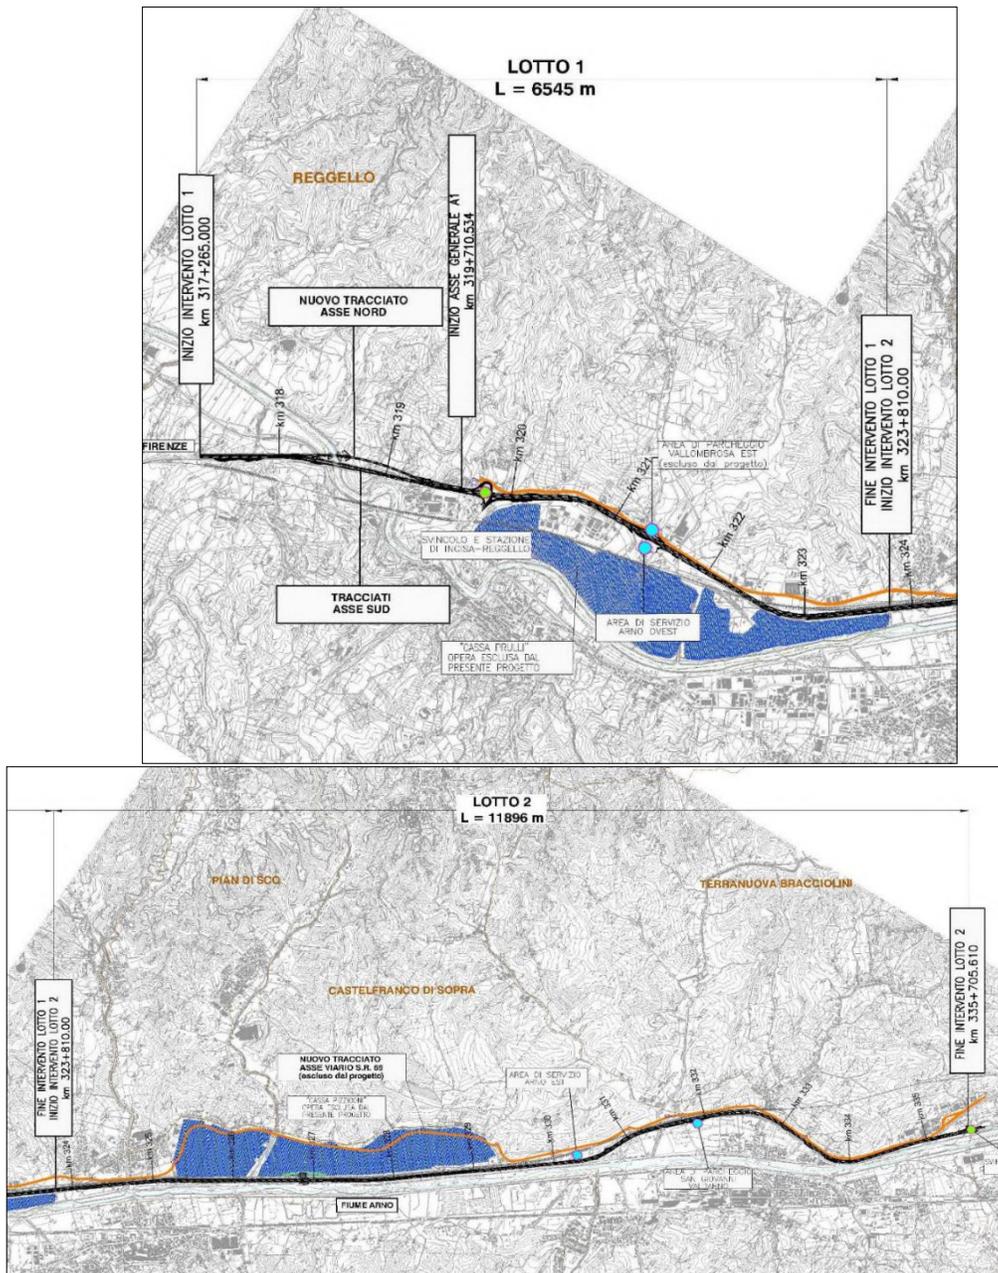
Lotto 1 e Lotto 2: stralcio planimetrico da STD0015 per l'inquadramento generale di intervento
